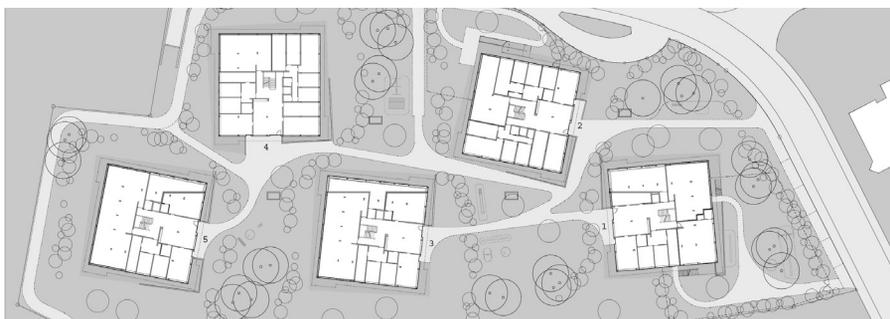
Wohnüberbauung Steinacker, Lageplan
